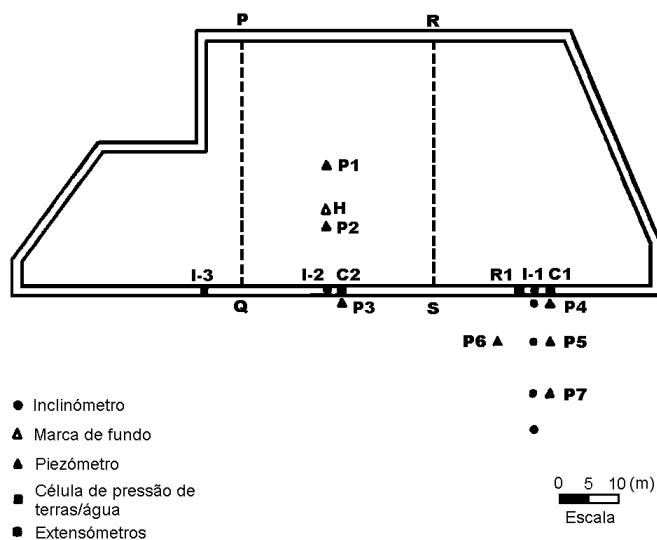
Planta de instrumentação – escavação TNEC (Ou et al., 1998)
